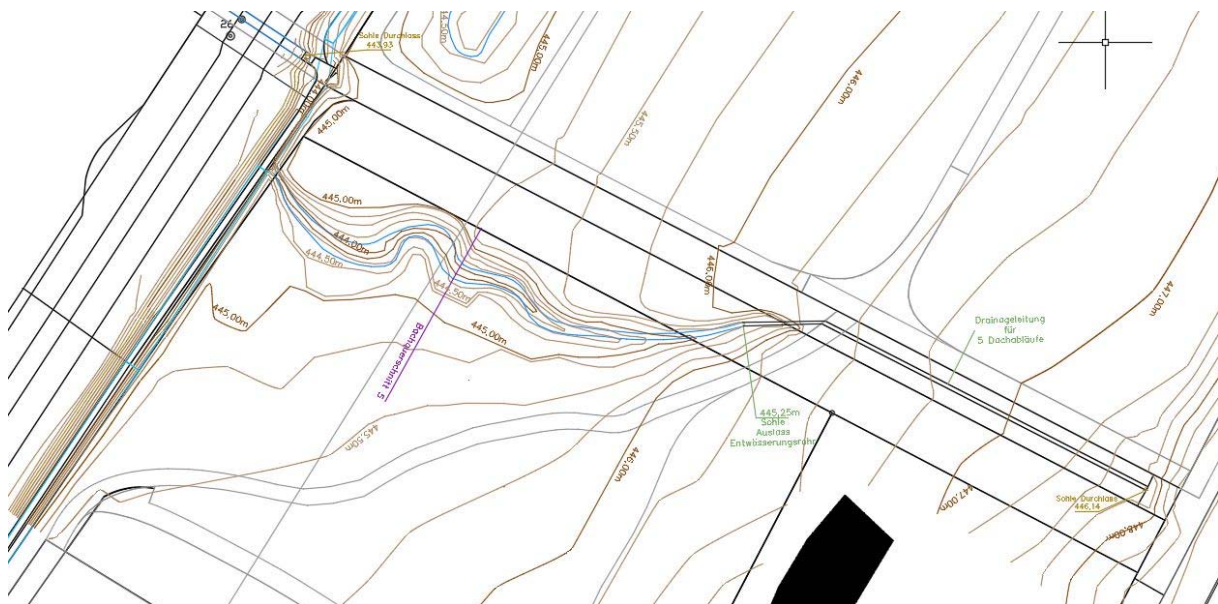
Ausschnitt Lageplan des Bachquerschnittes im südlichen Parkbereich
